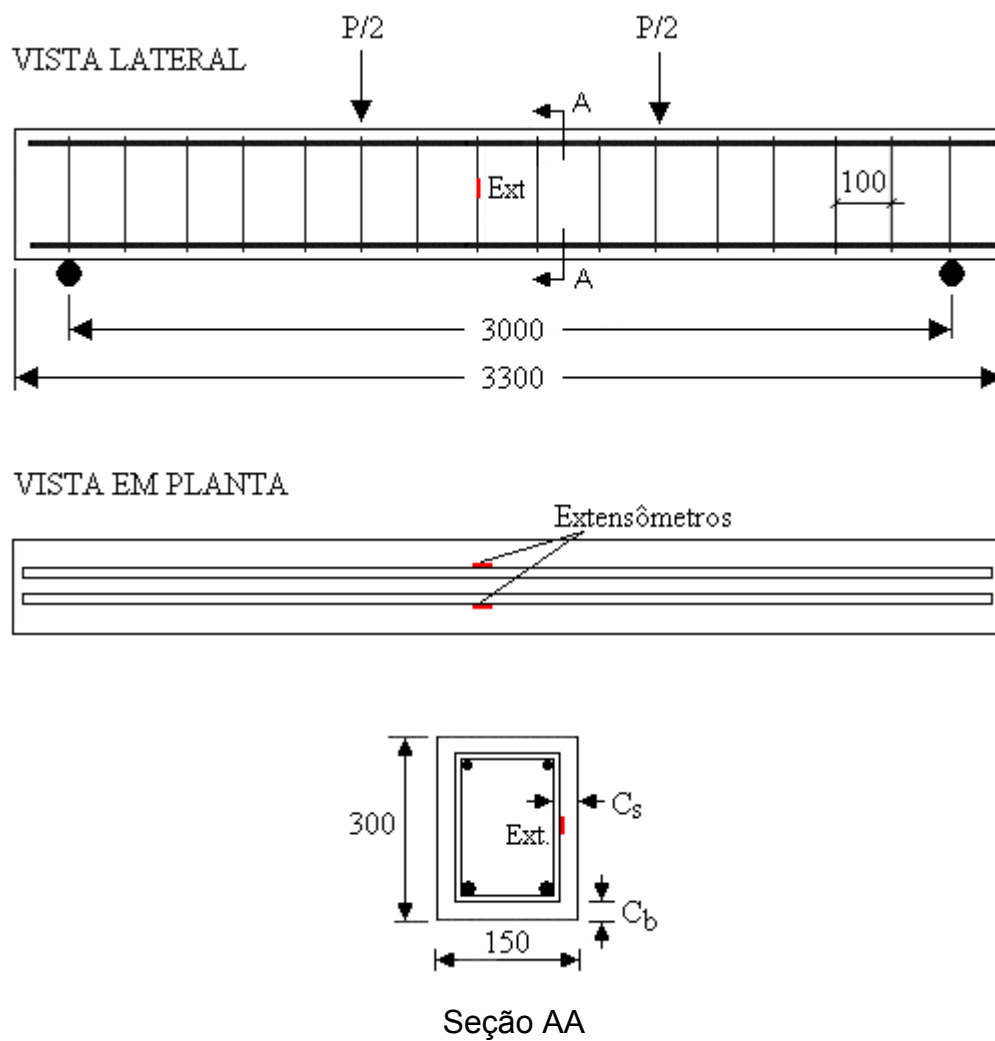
Características geométricas das vigas 1 e 2
